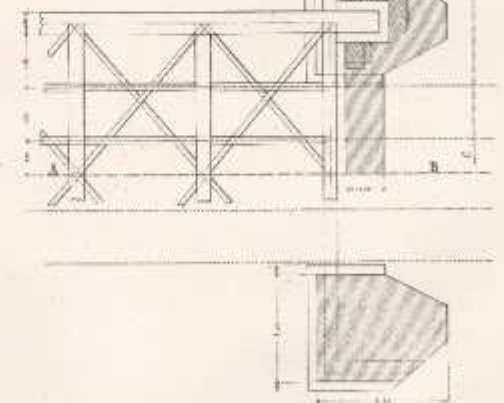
Plan et fondation d'une pile à 0 011 p^m
